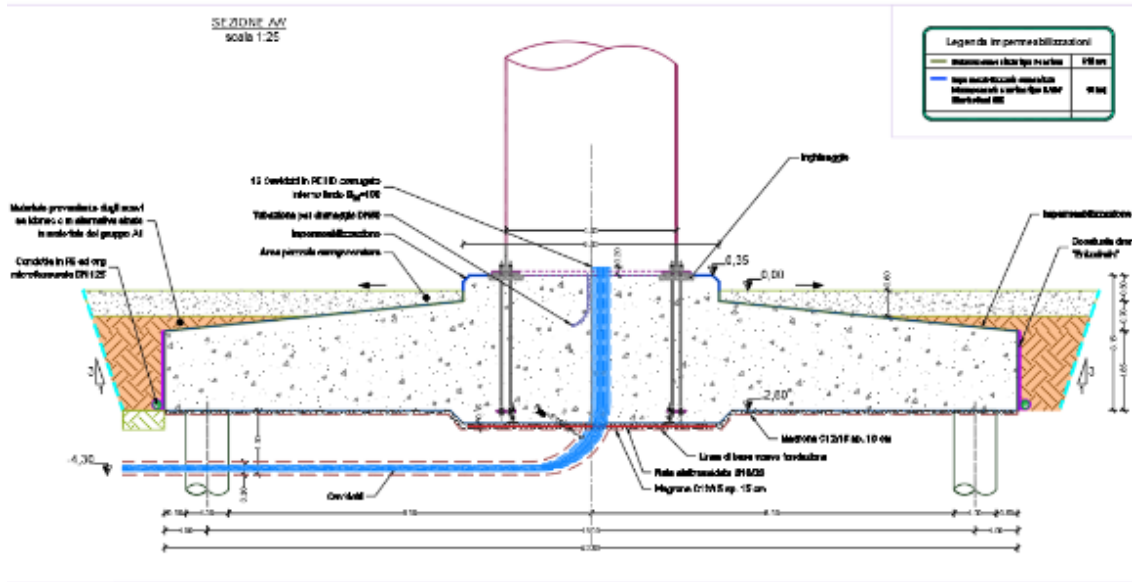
Tipologia della fondazione su pali prevista -diametro fondazione 20,00 m
